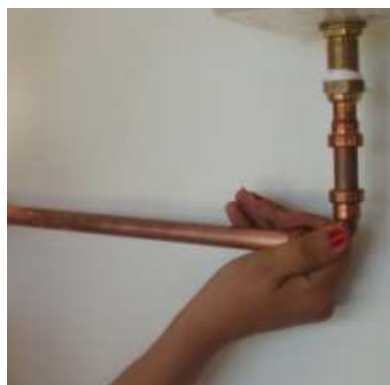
Montaje de tubería de cobre mediante unión push-fit
